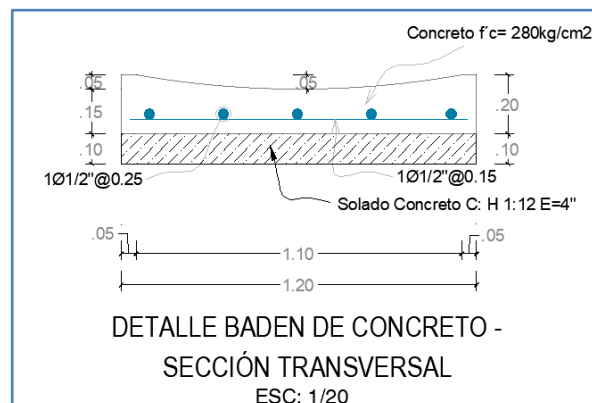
Detalle canal de concreto Armado en intersecciones.
